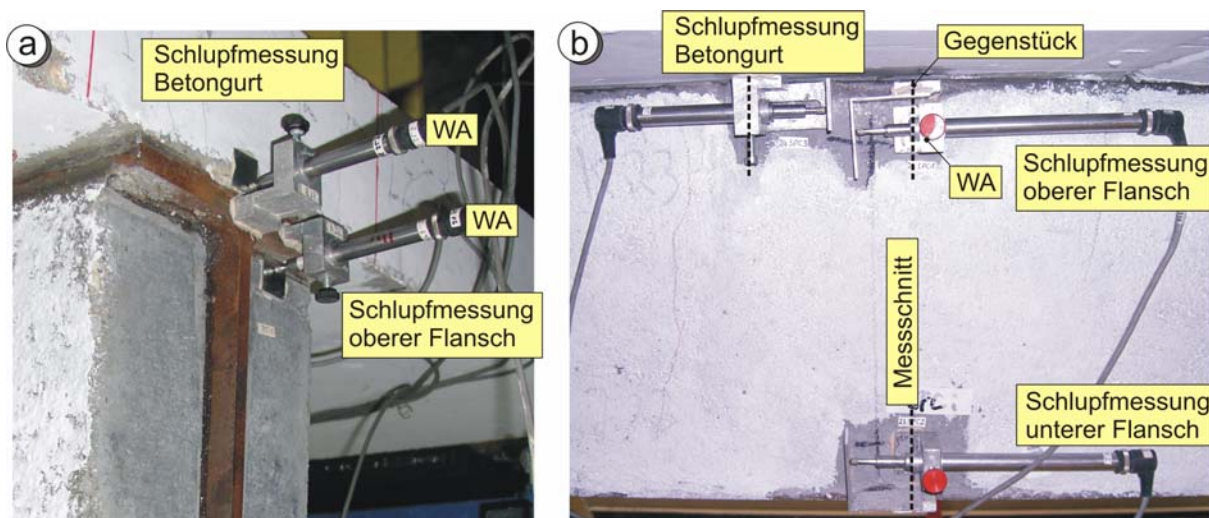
Schlupfmessung zwischen dem Betongurt bzw. dem Kammerbeton und dem Stahlprofil (a) Endschlupf, (b) Schlupf im Schnitt B
